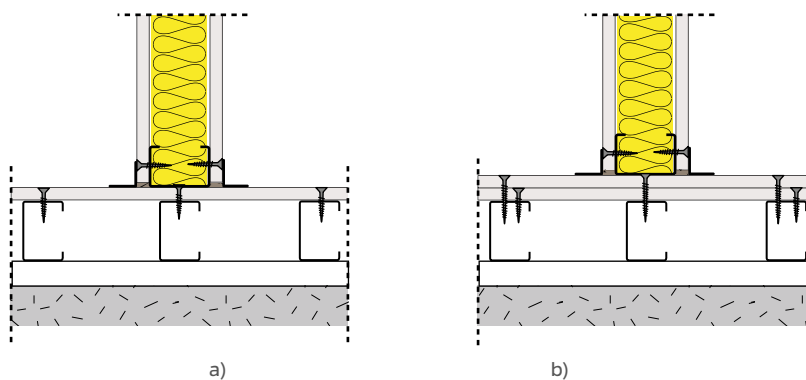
Ligações em encontros: a) Placa simples; b) Placa dupla.
